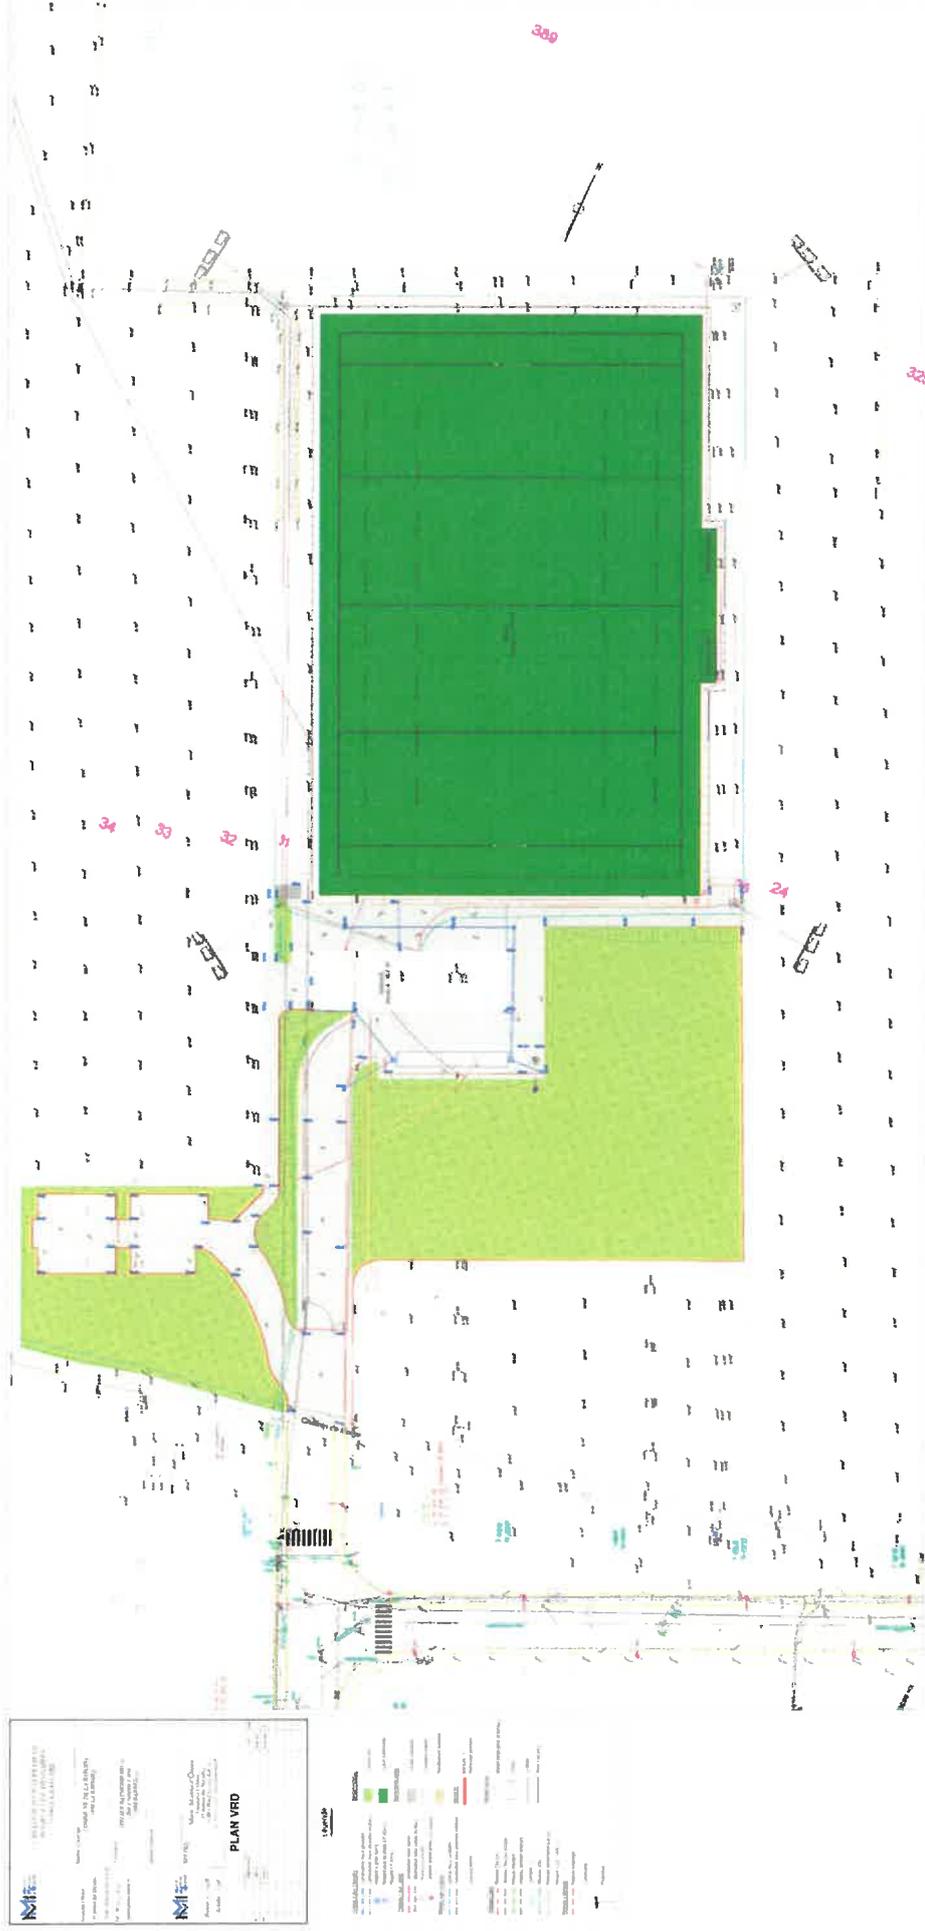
Plan voiries et réseaux divers (Source : Atelier Raymond Brun Architecte)
